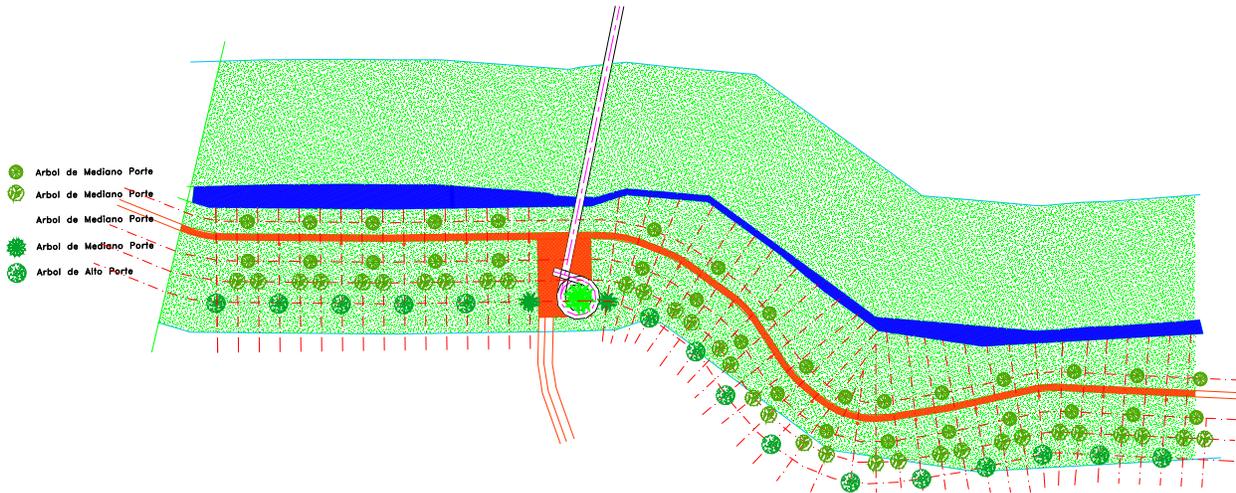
Propuesta paisajística de siembra de especies nativas en las ZMPA del Plan Parcial
